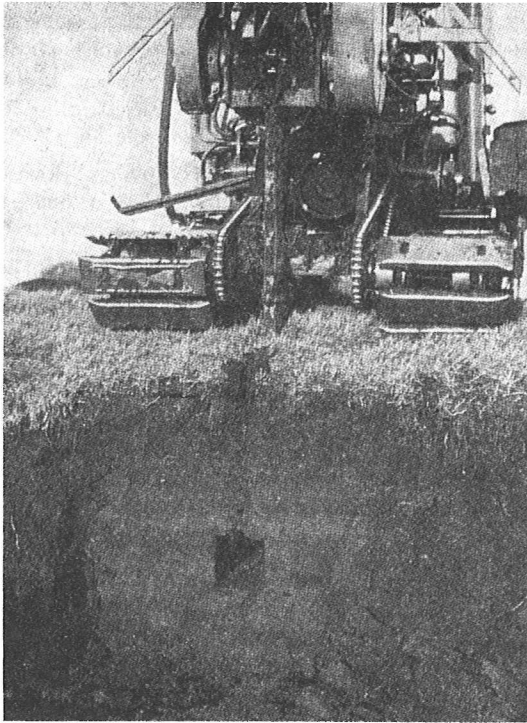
Mecking-Dränfräse für Moor, Fräsdrän: Höhe = 20 cm, Breite = 15 cm
